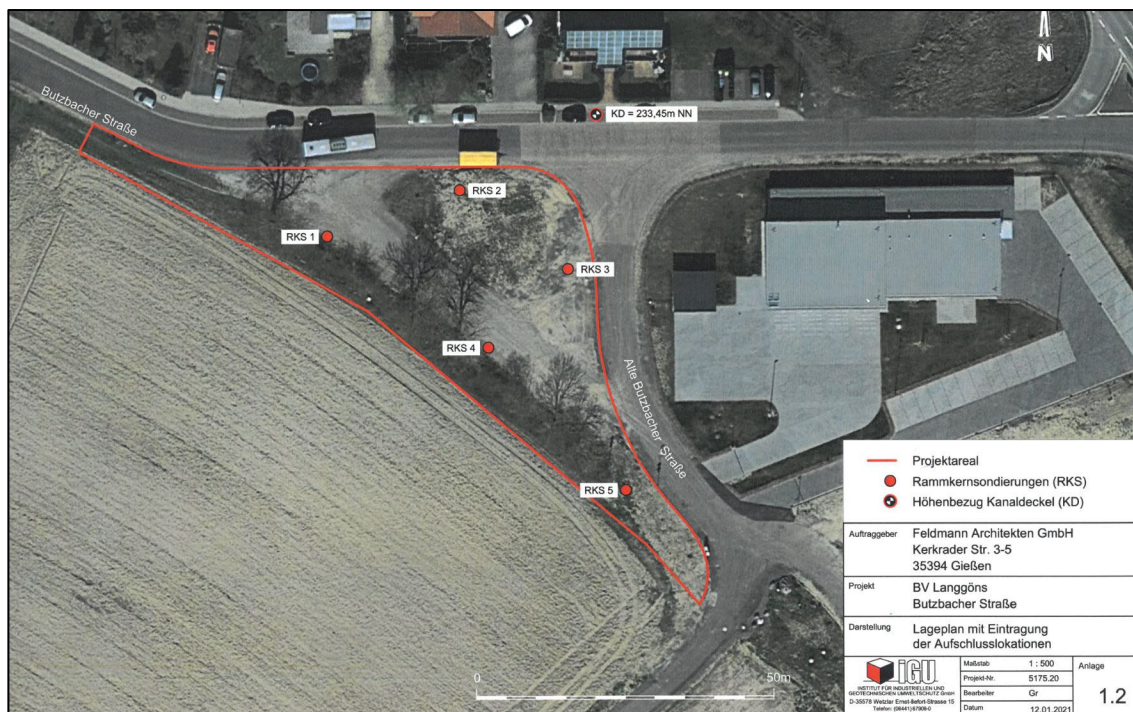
Lageplan – Rammkernsondierungen (IGU, Wetzlar)
